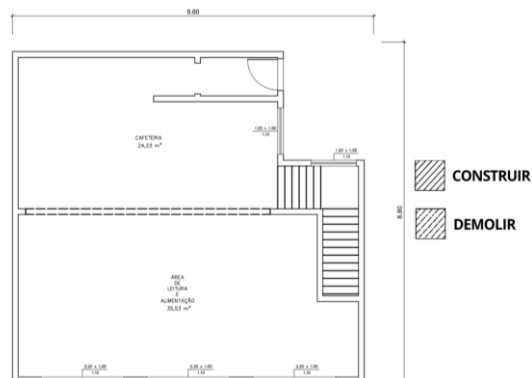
PLANTA DE REFORMA 1 – TÉRREO
